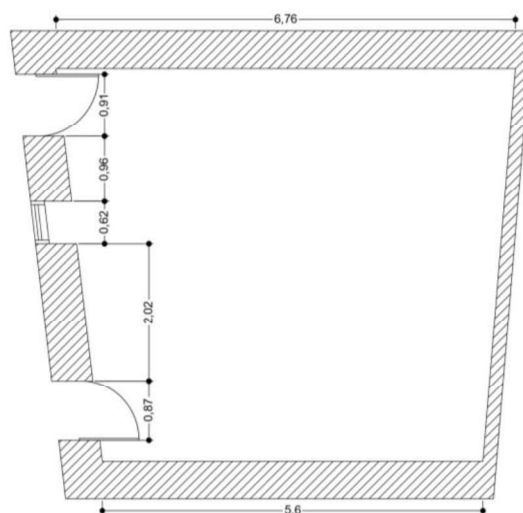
Planta de levantamento, piso inferior da moradia 2. Fonte: Autor
